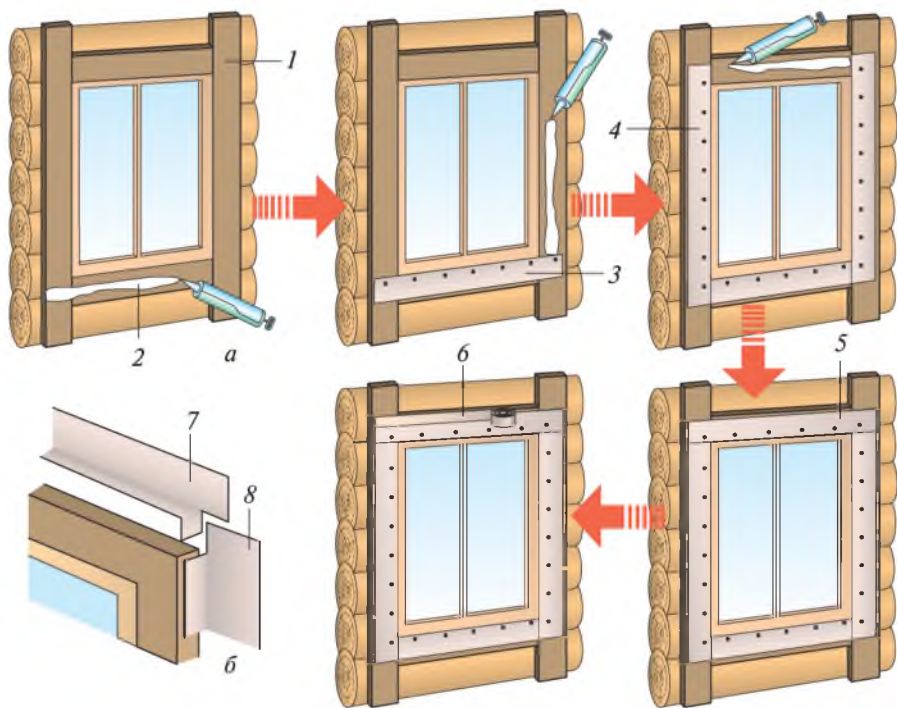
Гидроизоляция оконных и дверных проемов: а — заподлицо со стеной; б — выступающего из стены; 1 — обрешетка; 2 — силиконовый герметик; 3 — нижний фартук из кровельной жести; 4 — то же, боковой; 5 — то же, верхний; 6 — алюминиевый скотч или герметик; 7 — верхний Г-образный фартук из кровельной жести; 8 — то же, боковой
